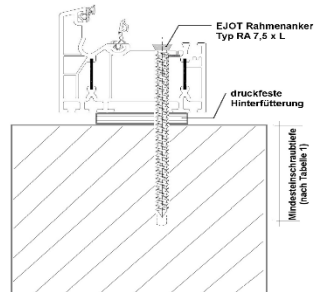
Montageausführung: Anschluss für Kunststofffenster ohne Stahlarmierung
